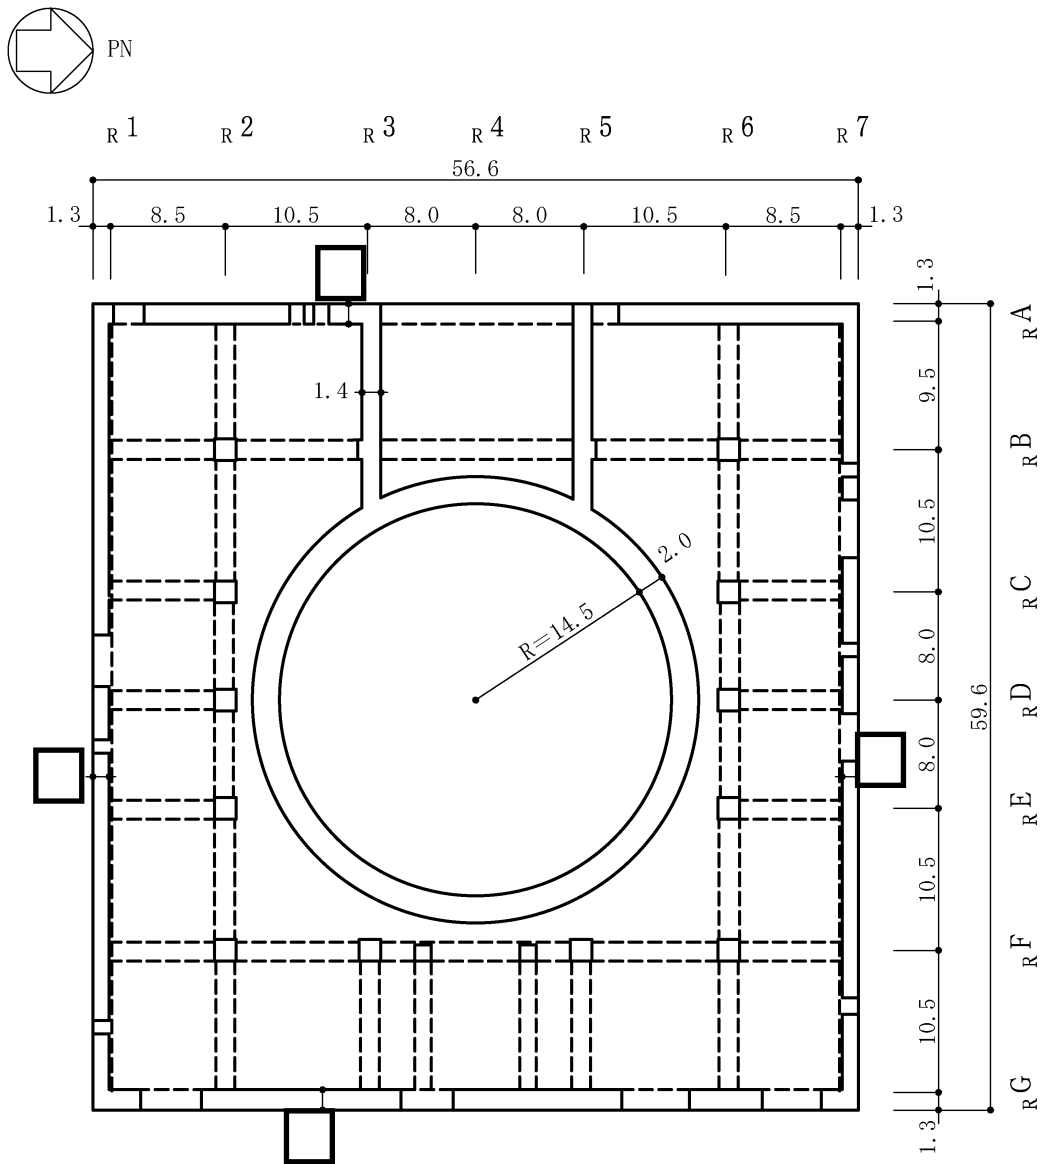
原子炉建屋の概略平面図 (1F, T.M.S.L. 12.3m) (単位:m) (4/9)
